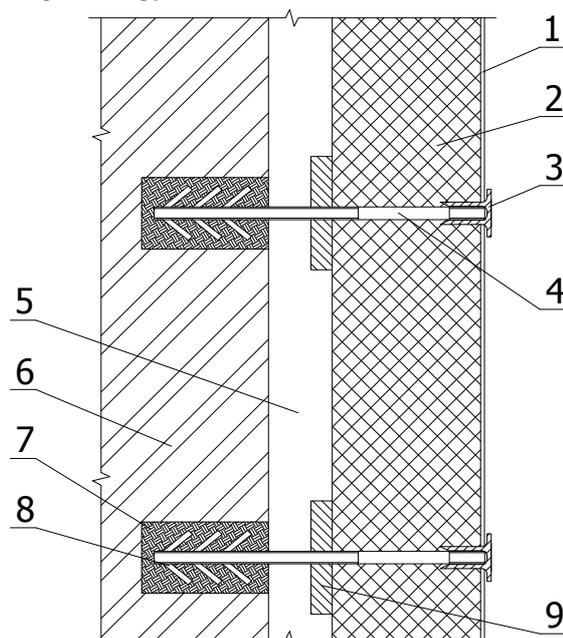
Конструктивное решение системы утепления стен «Термический экран»: 1 – защитное покрытие; 2 – теплоизоляционный слой из плитного утеплителя; 3 – полиэтиленовая втулка-заглушка; 4 – стеклопластиковый анкер-кронштейн; 5 – воздушная прослойка (толщиной до 300 мм); 6 – утепляемая стена; 7 – цементно-песчаный раствор; 8 – анкерочная шайба; 9 – установочная шайба-ограничитель
